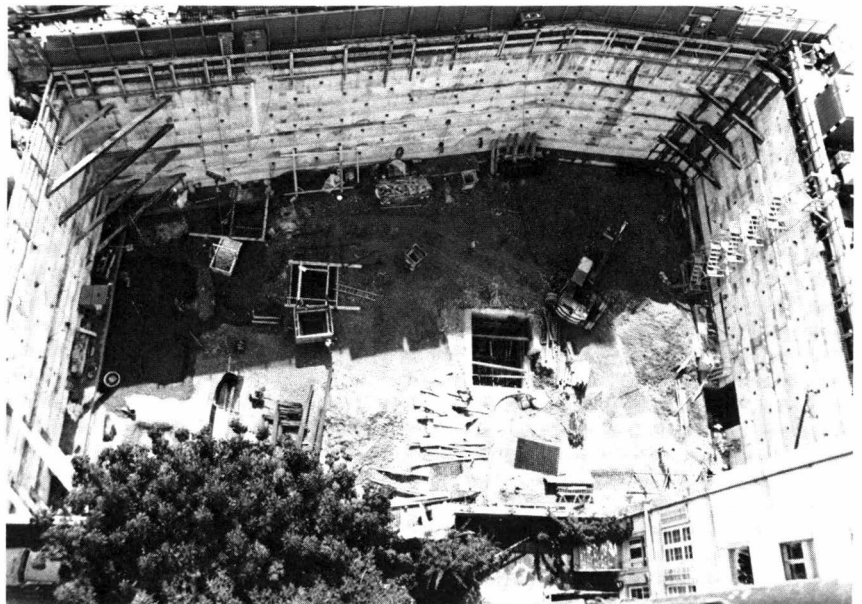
Baugrubensicherung mit rückverankerten Elementwänden. Erkennbar das Feinmaschige Netz der Arbeitsfugen und die BBRV-Gründungsanker – Enveloppe de la fouille avec joints de reprise et tirants BBRV – Excavation with tie-back walls. Note pattern of construction joints and BBRV earth anchors
